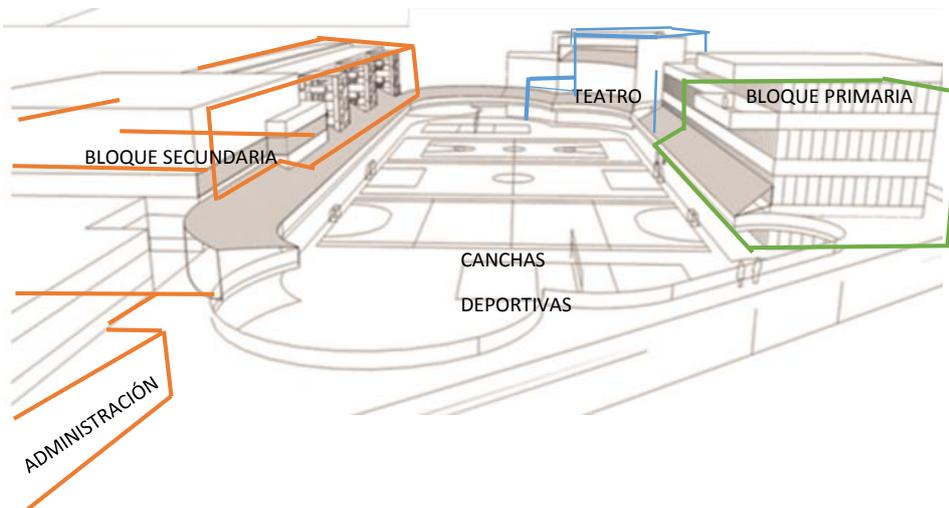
Colegio San Silvestre. Estructura de la forma final del edificio.
